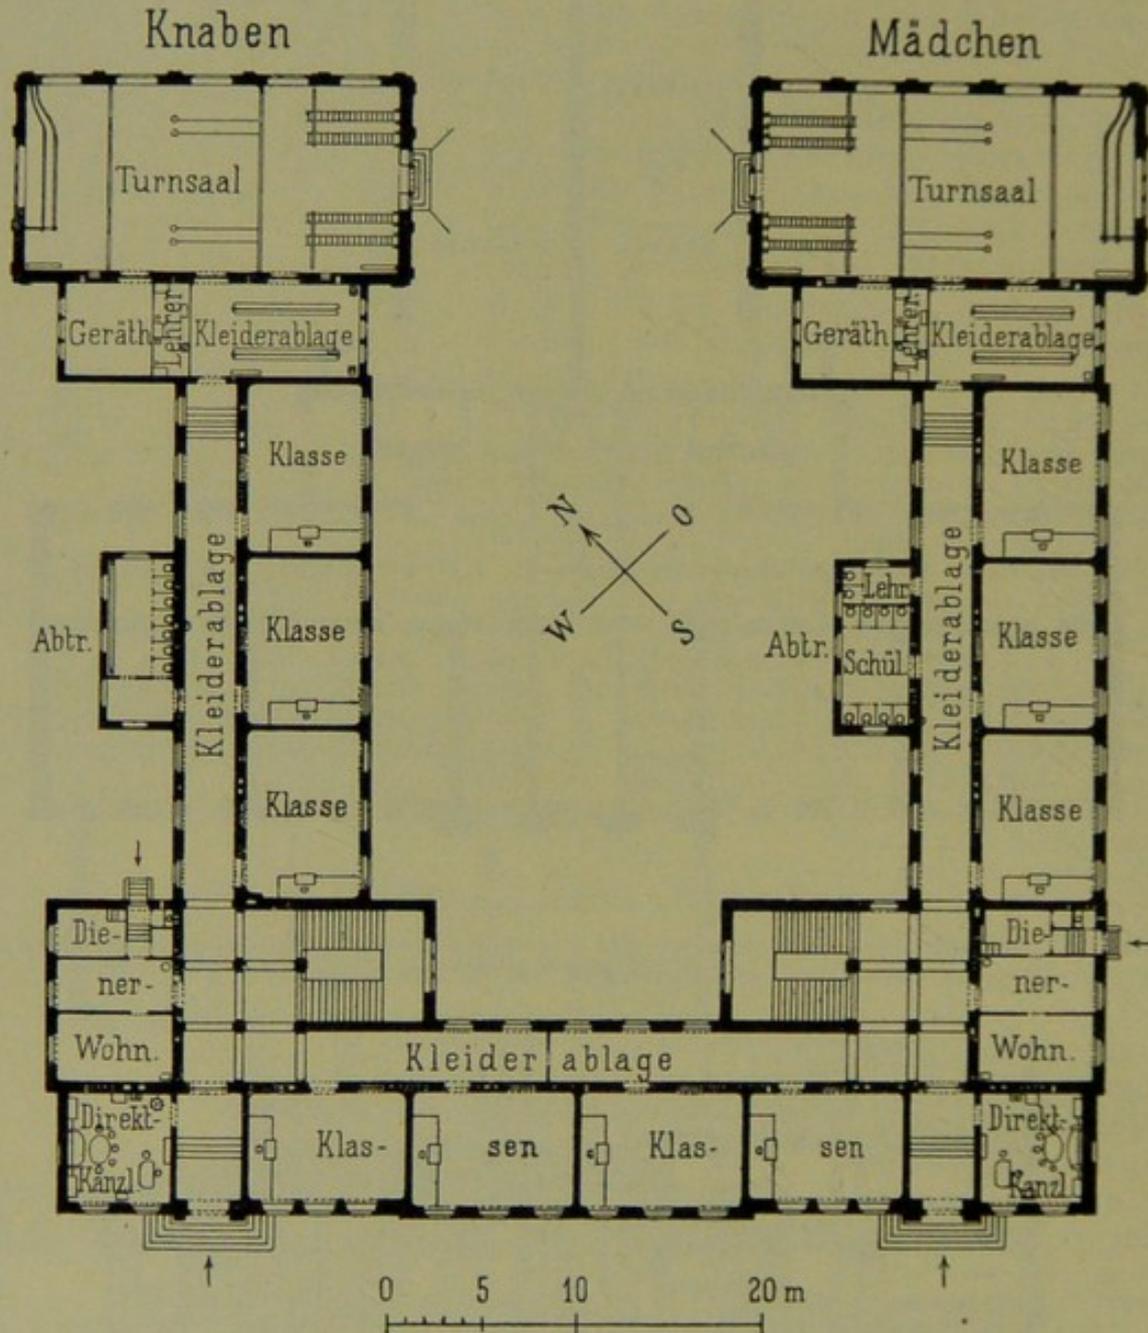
Neunundzwanzigklassige Kaiser Franz Josef-Jubiläumsschule in Floridsdorf, (Wien). Grundriß des Erdgeschosses. Nach Gebr. DREXLER.
